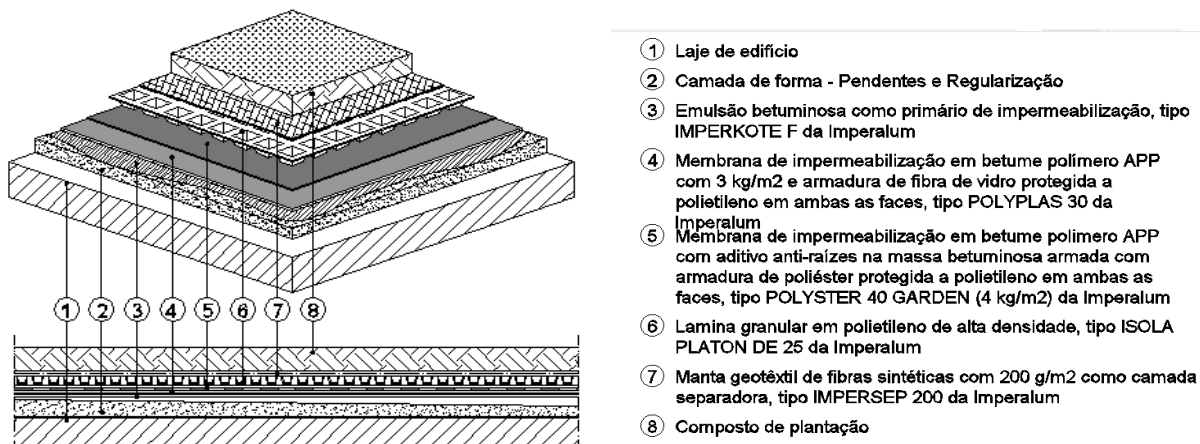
(retirada de [15]): Pormenor da constituição do sistema de impermeabilização da laje
